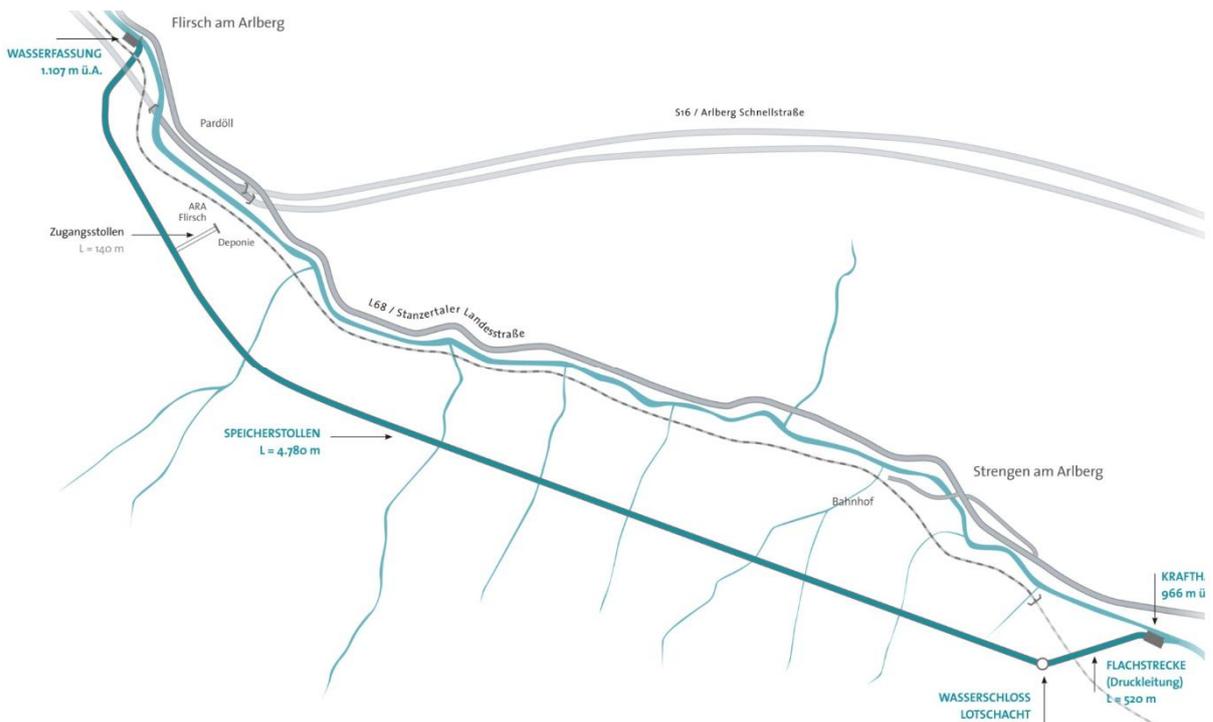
Übersicht Grundriss WKW Stanzertal [16]
